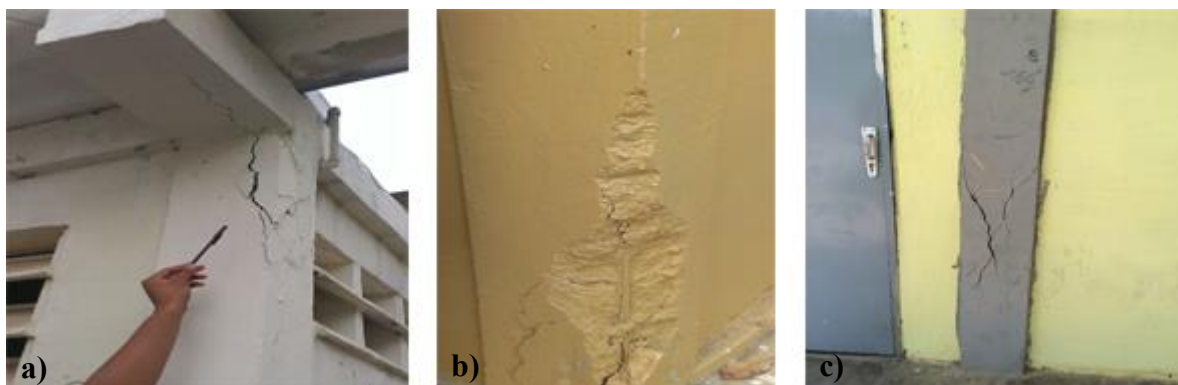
Fallas observadas: a) *Fisuración de la junta viga columna, mayor de 1,5 cm en el módulo*, b) *Desprendimiento del recubrimiento y delaminación del acero en el módulo 4*, c) *Grietas en forma de equis en el primer tercio de la columna y Abombamiento del concreto en la zona del módulo 8
